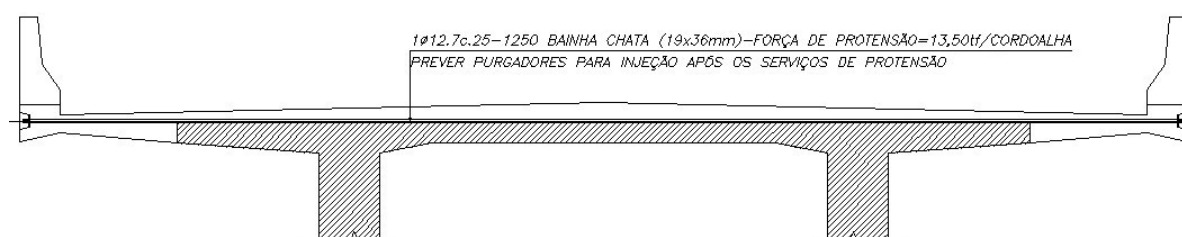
Posicionamento e especificação da armadura transversal de protensão para o alargamento e reforço da laje.
